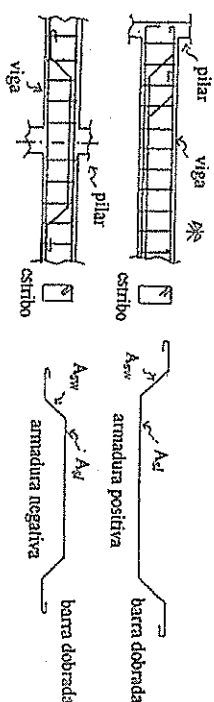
Armadura para cisalhamento formada por barras dobradas e estribos
